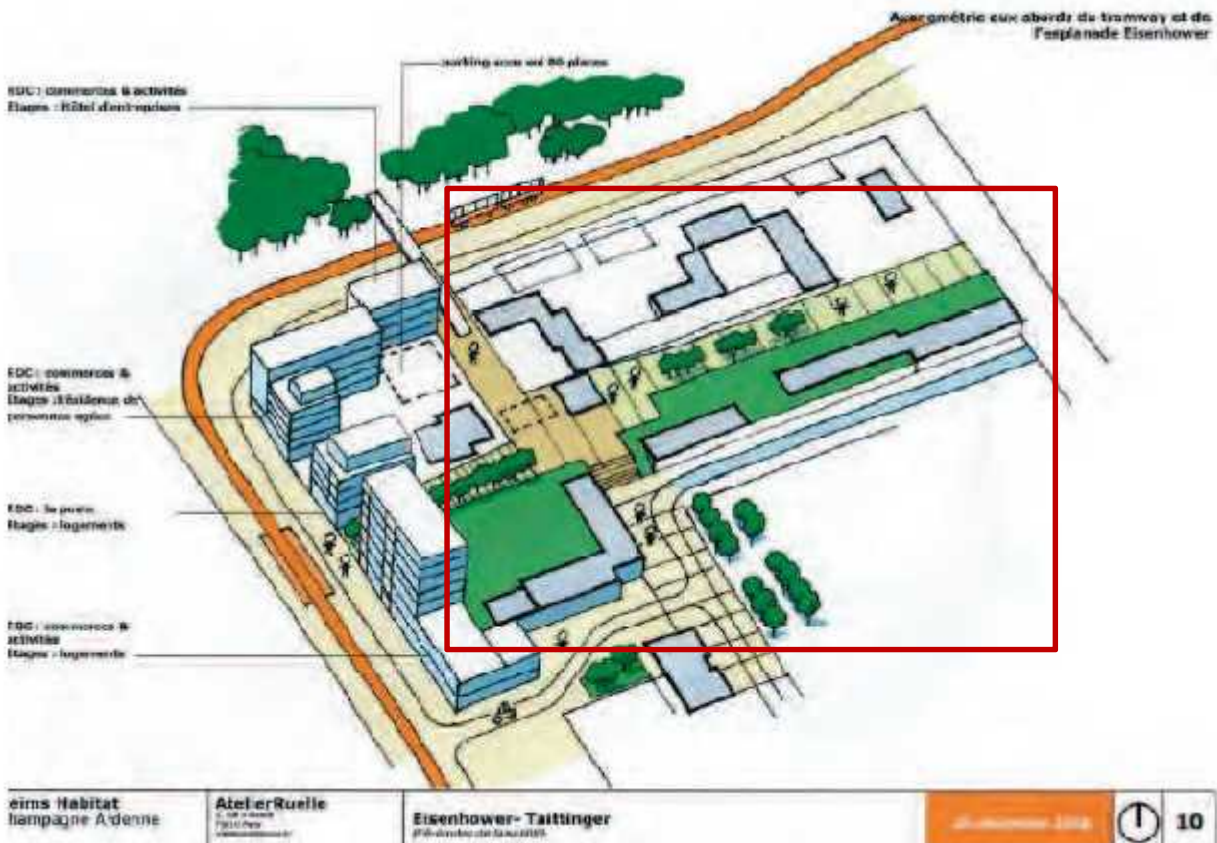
Secteur Eisenhower, 1ère étape (Reims).²³
